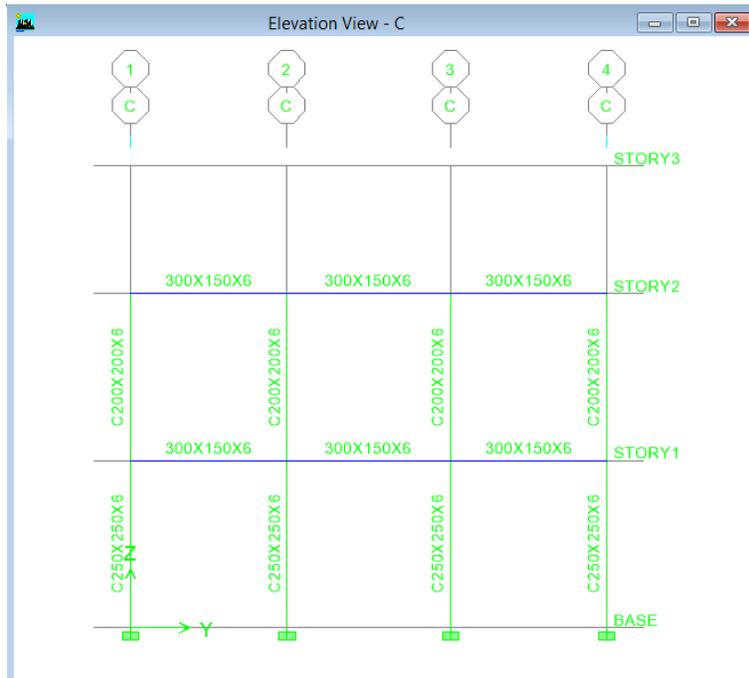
; Secciones Asignadas EJE C Del diseño estructural metálico
